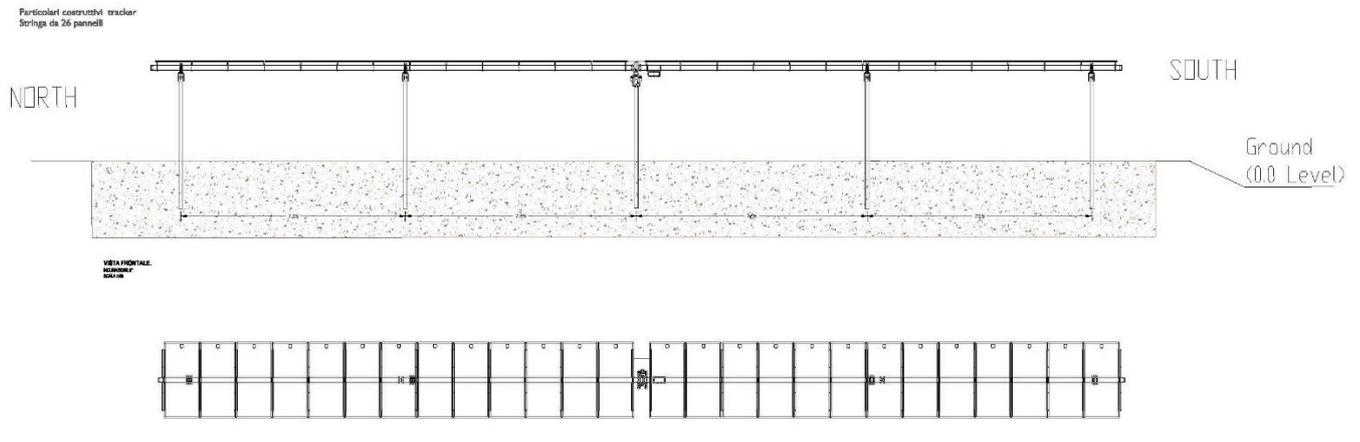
Vista laterale e vista dall'alto della singola stringa da 26 moduli
